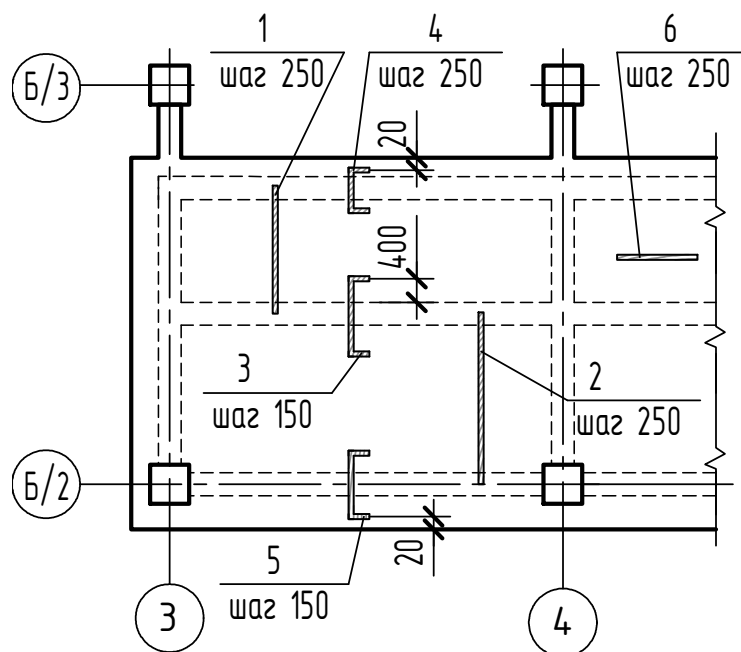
Изображение на схеме армирования отдельных арматурных стержней с одинаковым шагом
